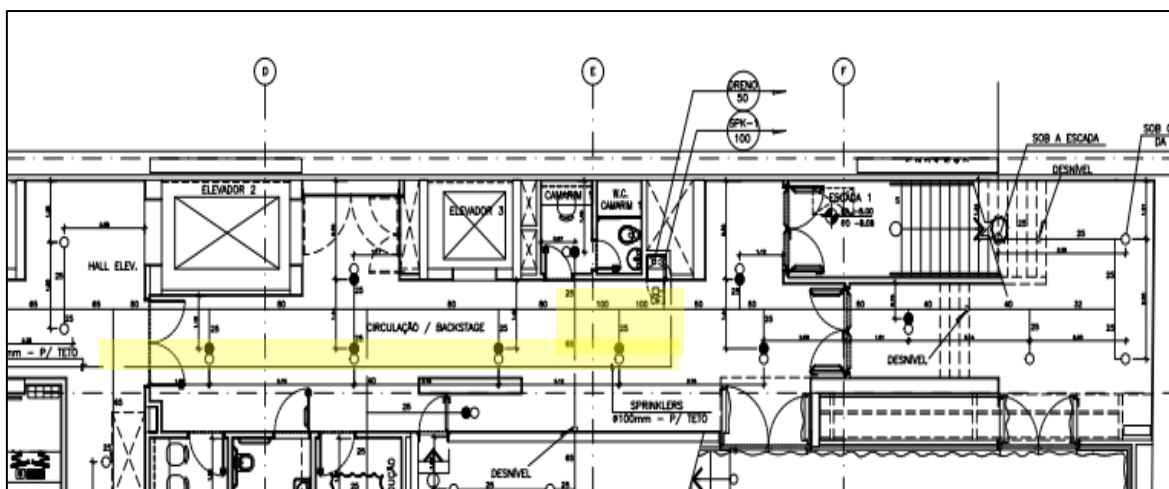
Demonstração da Patologia da Tubulação de aço galvanizado de 100 mm – 2º Pavimento
